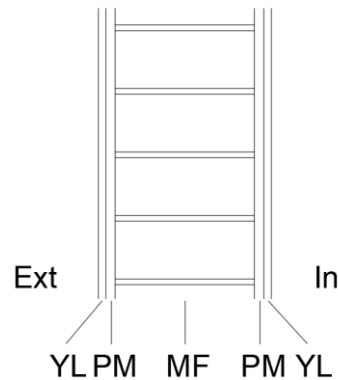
Esquema ubicación forjado. Fuente: Elaboración propia
